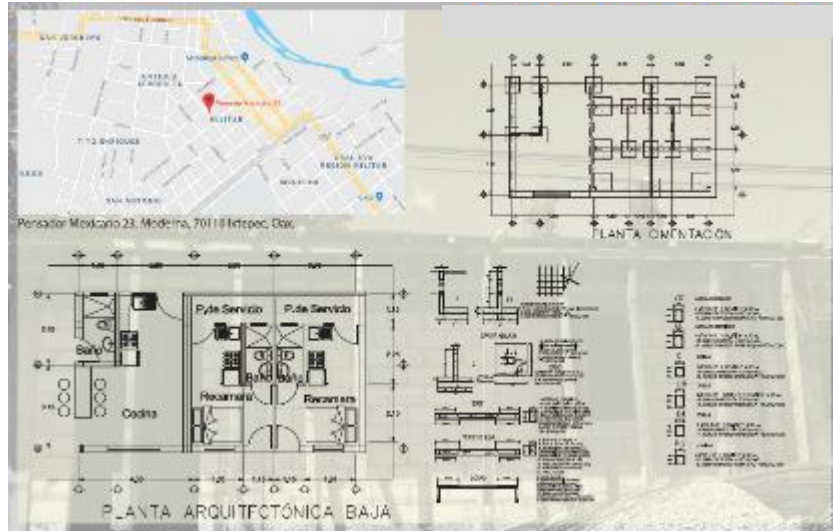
Proyecto de vivienda de la familia de María N. construida en Juchitán, Oaxaca. Fuente: Erick David Ramírez Pérez.
